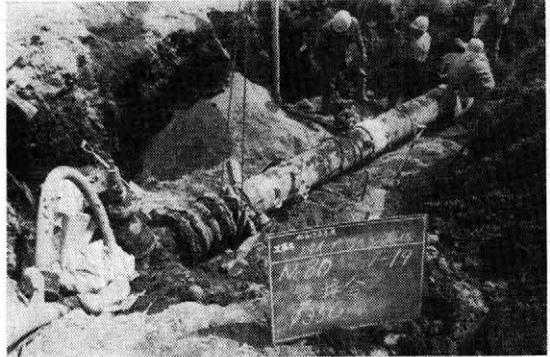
ヒューム管沈下に伴う継手漏水応急補修
